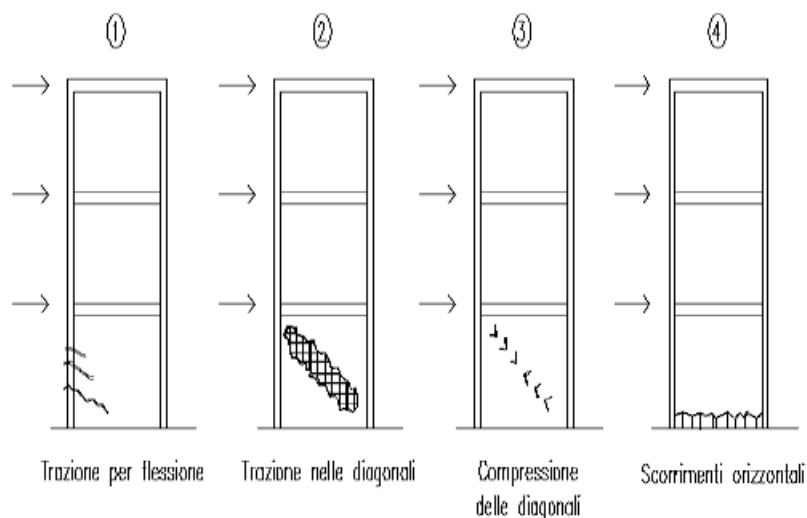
Modi di collasso di una parete in cemento armato sottoposta ad azioni orizzontali.
